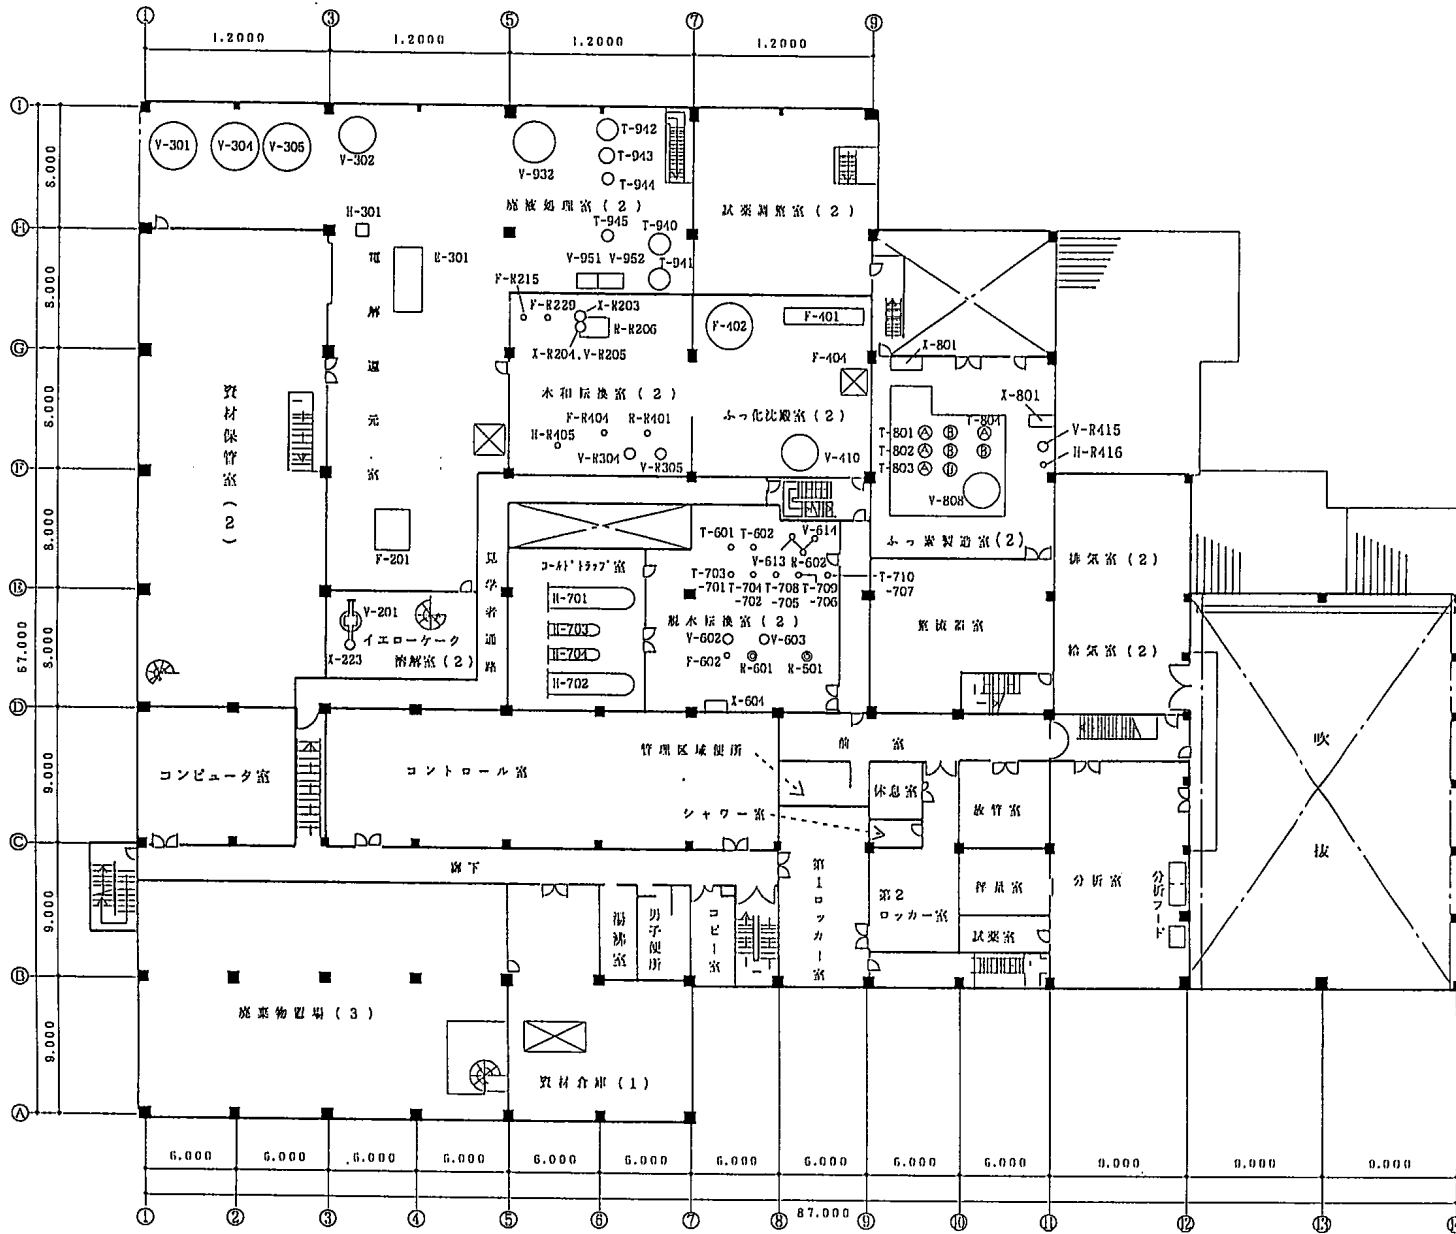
製錬転換施設主要機器配置平面図 (2 階)
